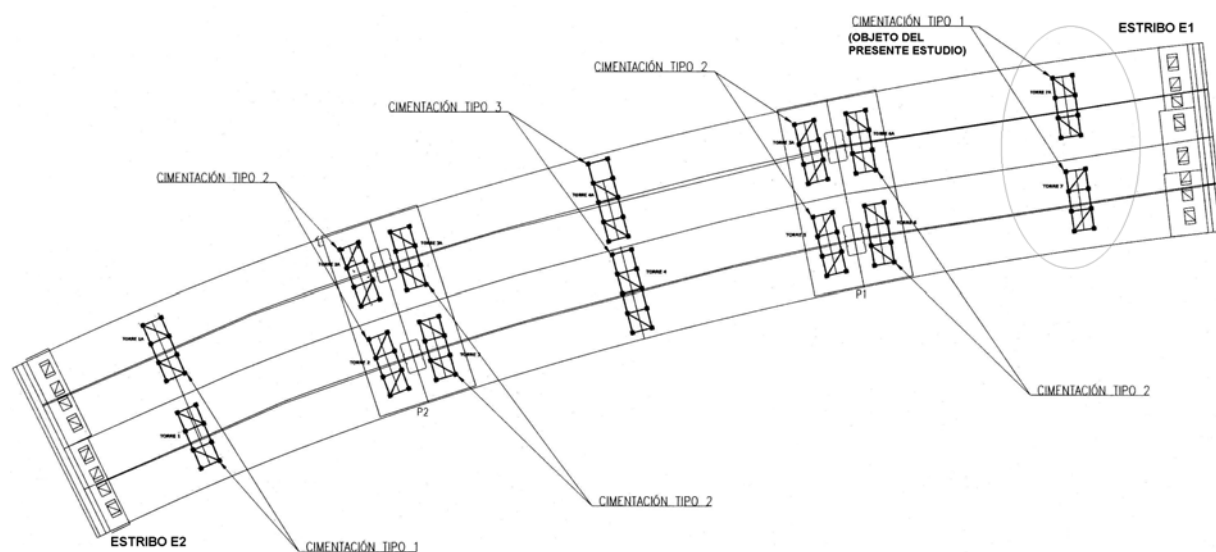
Esquema en planta de las torres de cimbra previstas para la construcción de los tableros del Viaducto de Aromeros.
